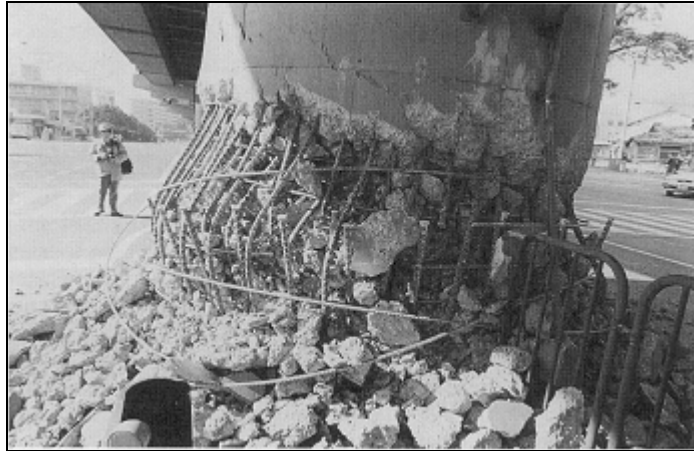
Falla en soldaduras de refuerzo longitudinal de columna, terremoto de Kobe 1995.
